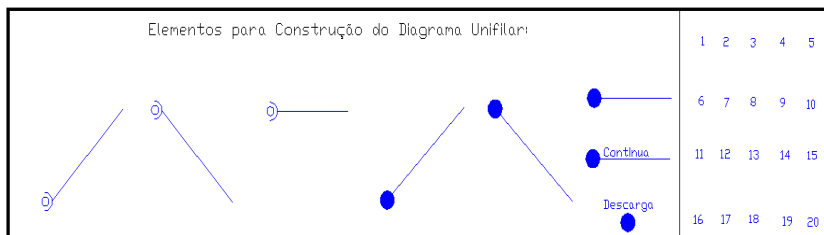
Elementos para construção do Diagrama Unifilar em plataforma CAD
